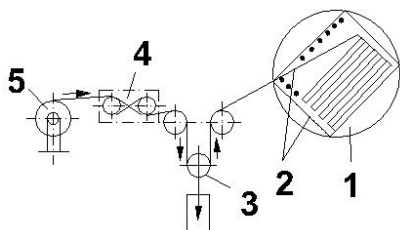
Схема непрерывного армивання поперечно напружених конструкцій на поворотному столі:
